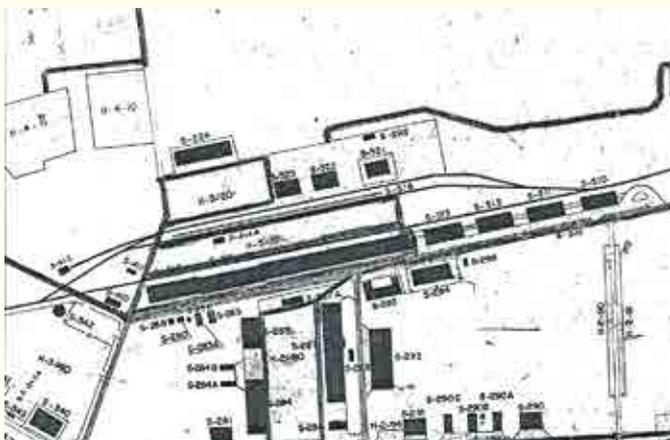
les installations ferroviaires de la « gare » et de ses entrepôts, d'après un plan général du dépôt. Collection P. Labrude.
